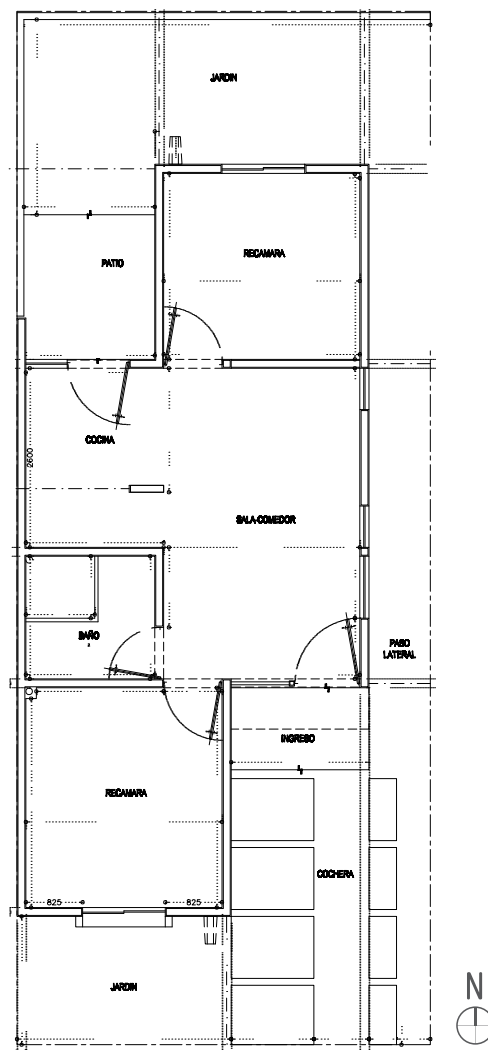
Tipo de vivienda aislada. Planta arquitectónica y 3D, sin escala
